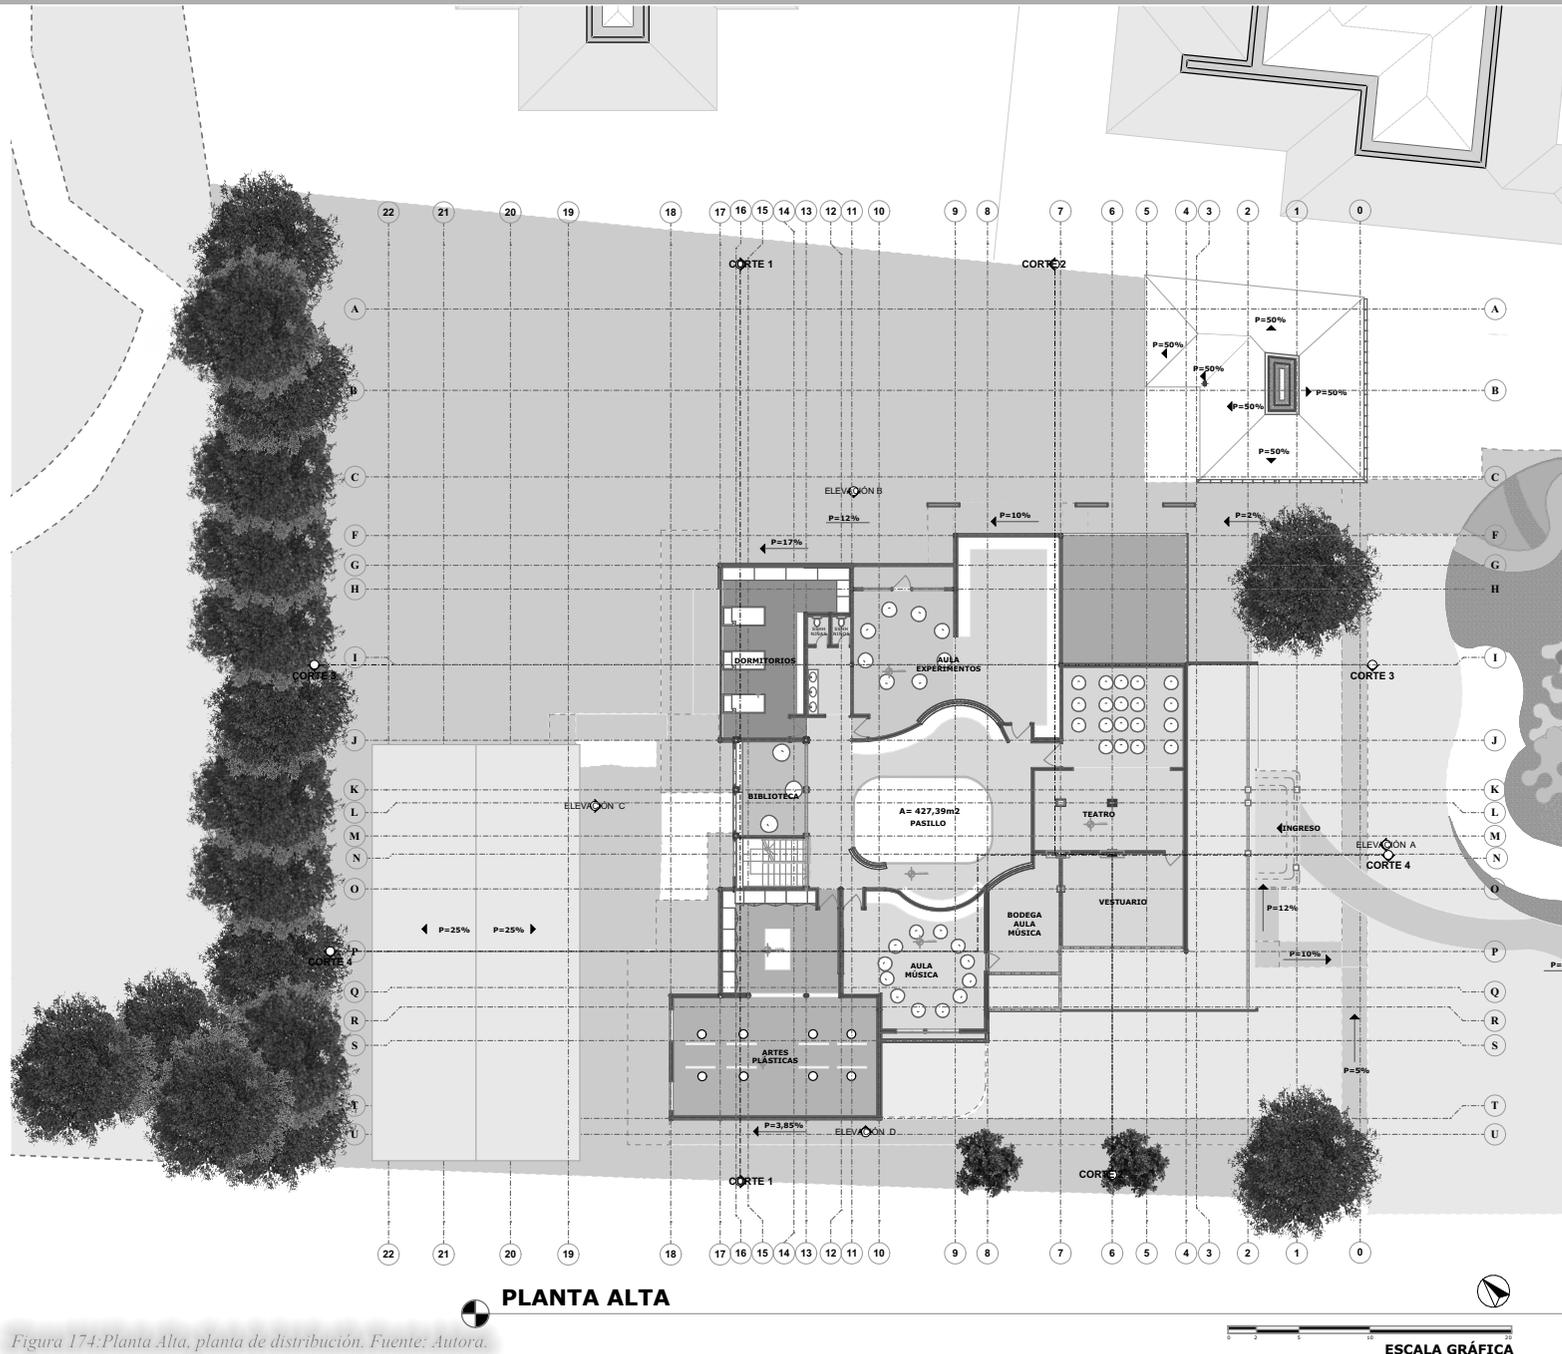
Planta Alta, planta de distribución. Fuente: Autora.
